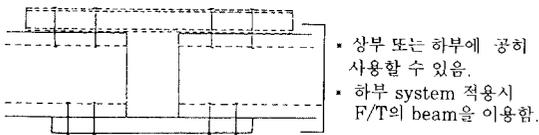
수직방향 elevation adjust도면(통상F/traveller 자체로 조정가능)
